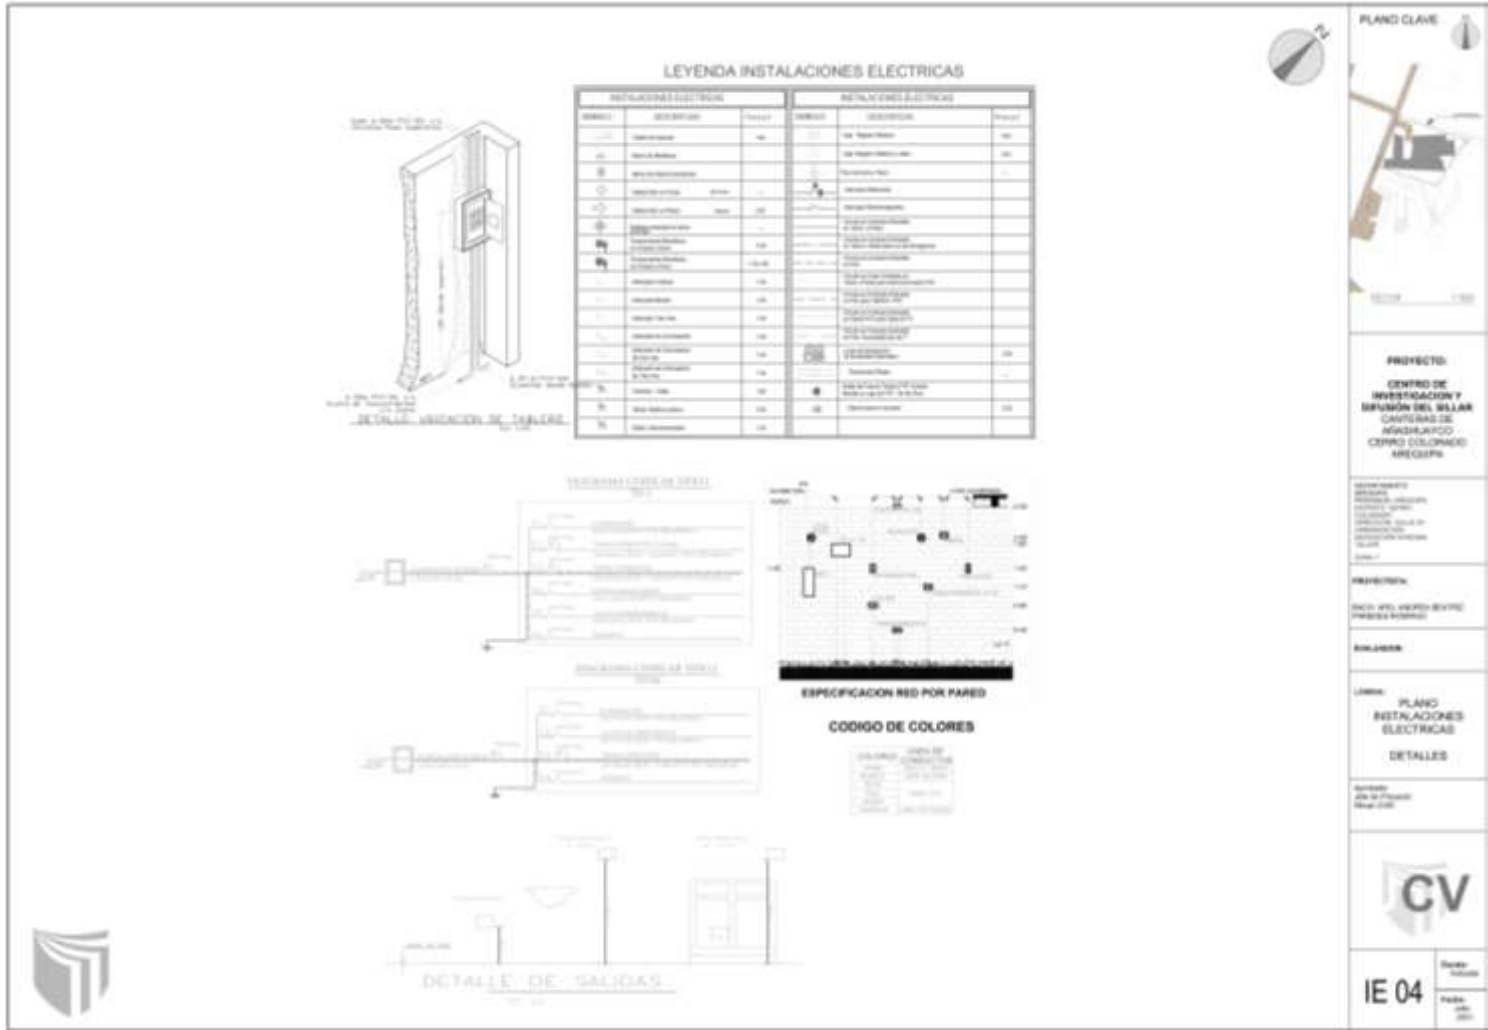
Plano de Instalaciones Eléctricas DETALLES– Sector –Área Académica– IE-03
